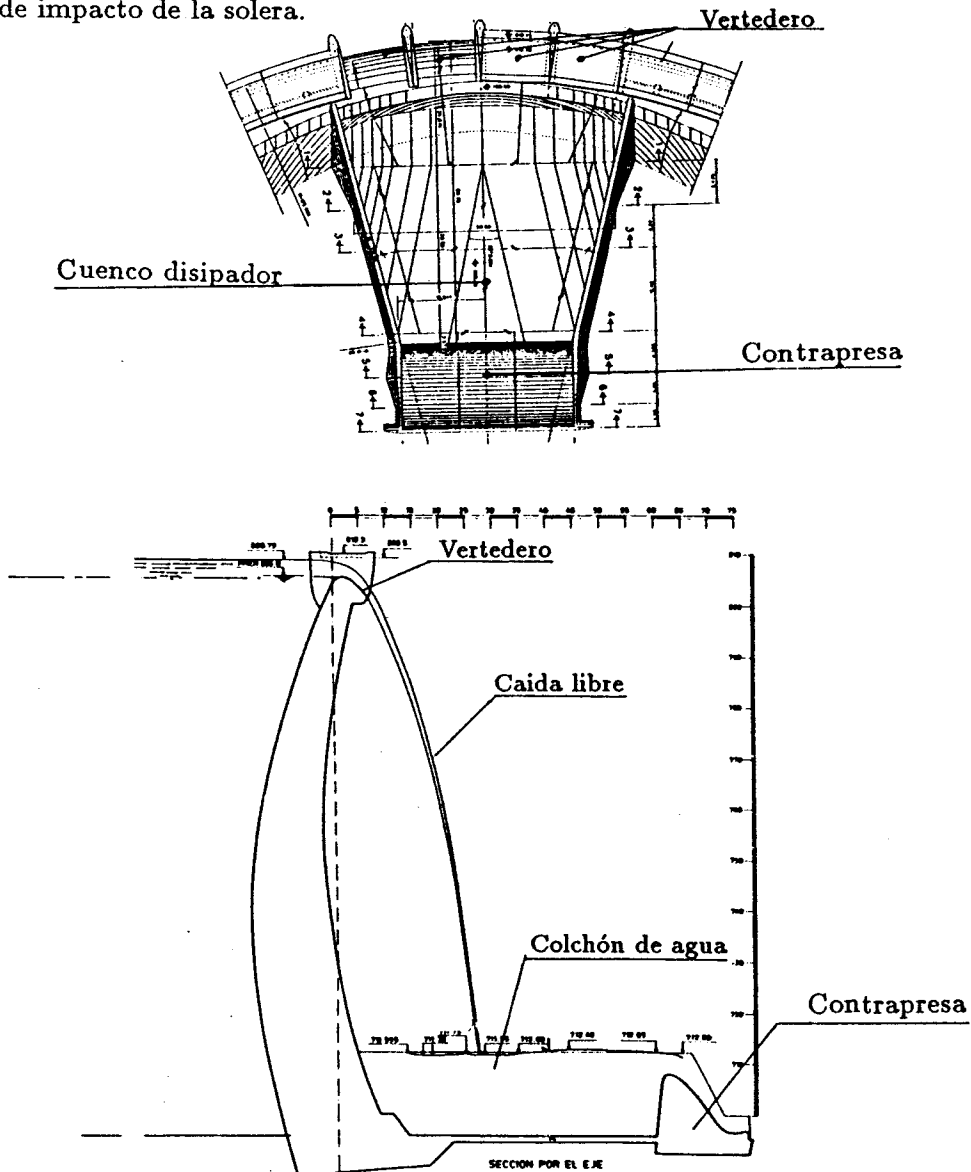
Planta y perfil del vertedero de la presa bóveda Llosa del Cavall, con su correspondiente disipador de energía a pie de presa.
